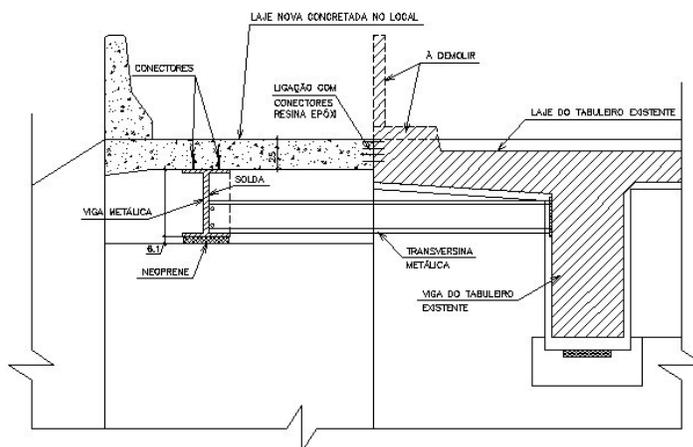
Detalhe do alargamento do tabuleiro com a utilização de vigas mistas.
